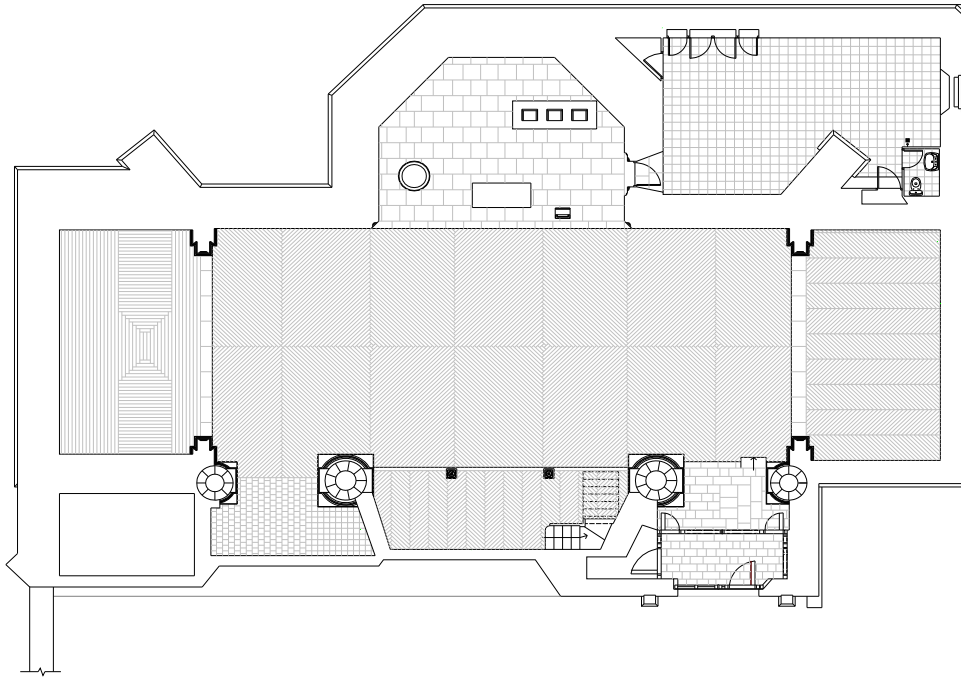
Plano en planta de la Iglesia Nuestra Señora de la Asunción en la que se observa los tipos de pavimento.
